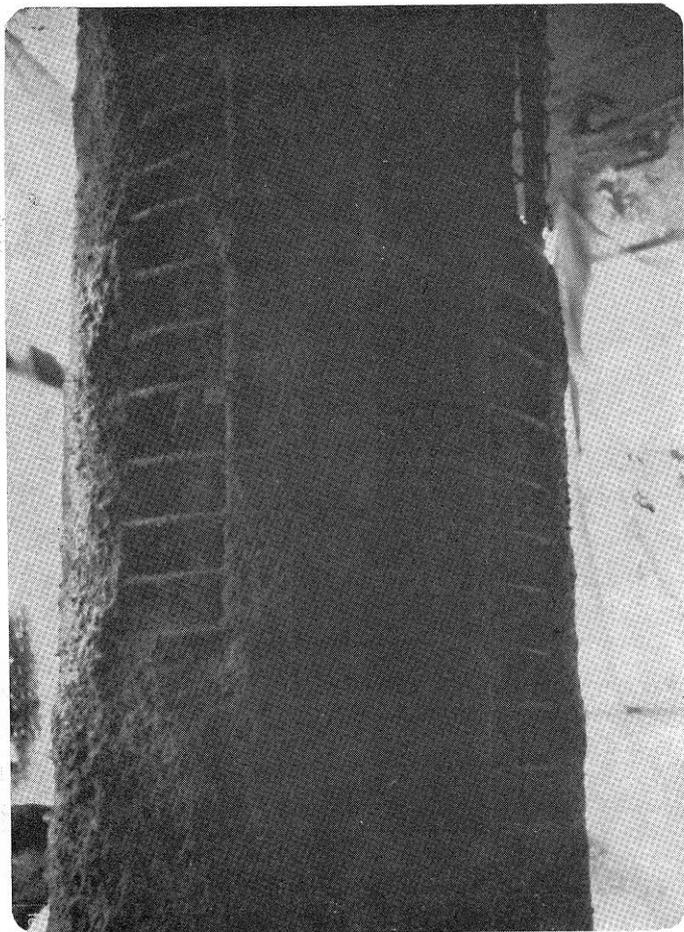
Recuperación de un pilar corroído. Chorreado de hormigón para restaurar la sección de hormigón y cubrir la nueva armadura suplementaria. Primeramente la estructura fue «preparada» con limpieza de herrumbre y del hormigón, chorro de arena y chorro de agua para saturar el hormigón «viejo» y aumentar la adherencia. La armadura suplementaria se apoya con pastillas sobre el núcleo de armadura y hormigón «viejo» (gentileza de Jato-cret).
